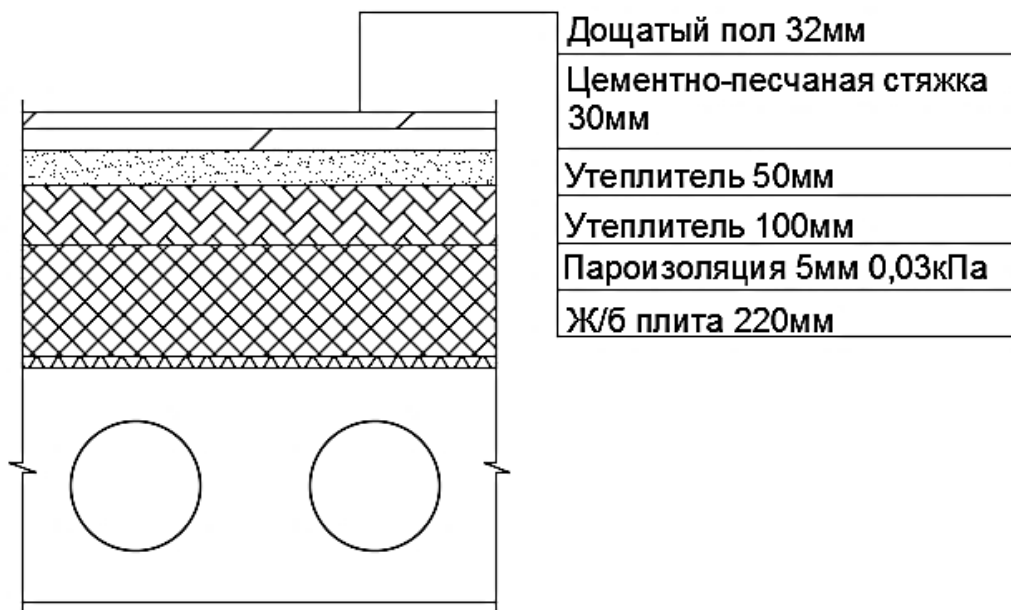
Сбор нагрузок на 1м² чердачное перекрытия.
